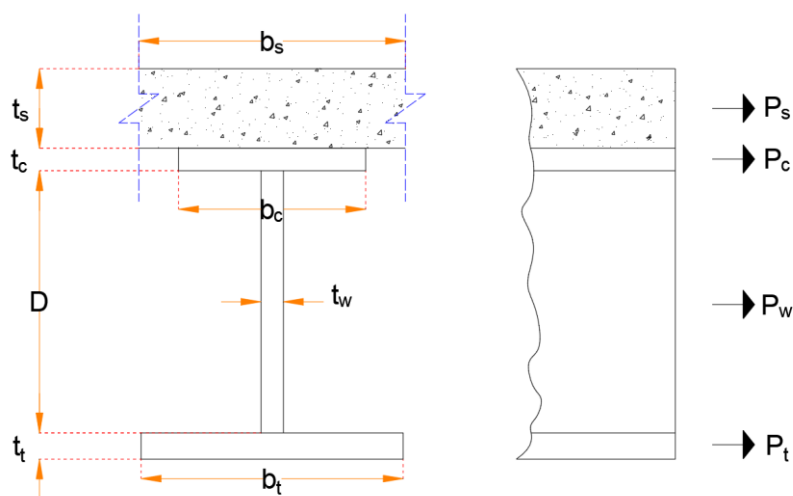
Esquema de fuerzas para el cálculo del momento plástico de una viga compuesta
